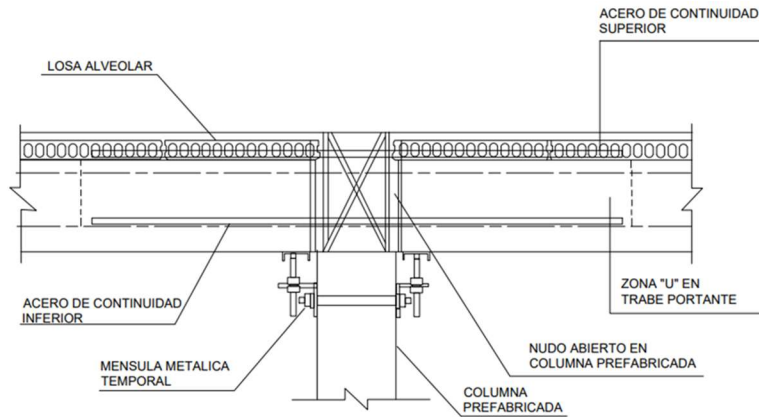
Unión de trabe rigidizante con la columna prefabricada.
